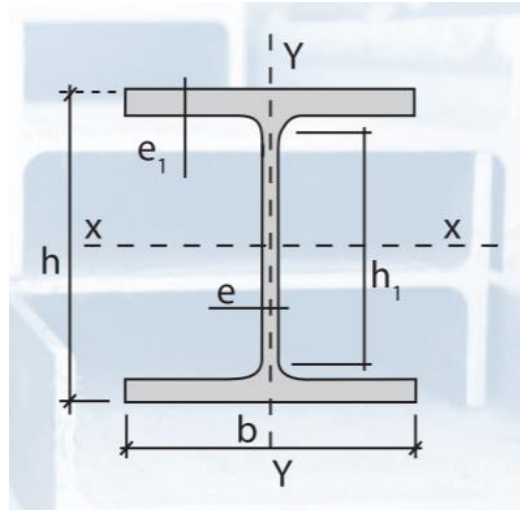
Imatge del perfil d'una columna. (Font:[13])
